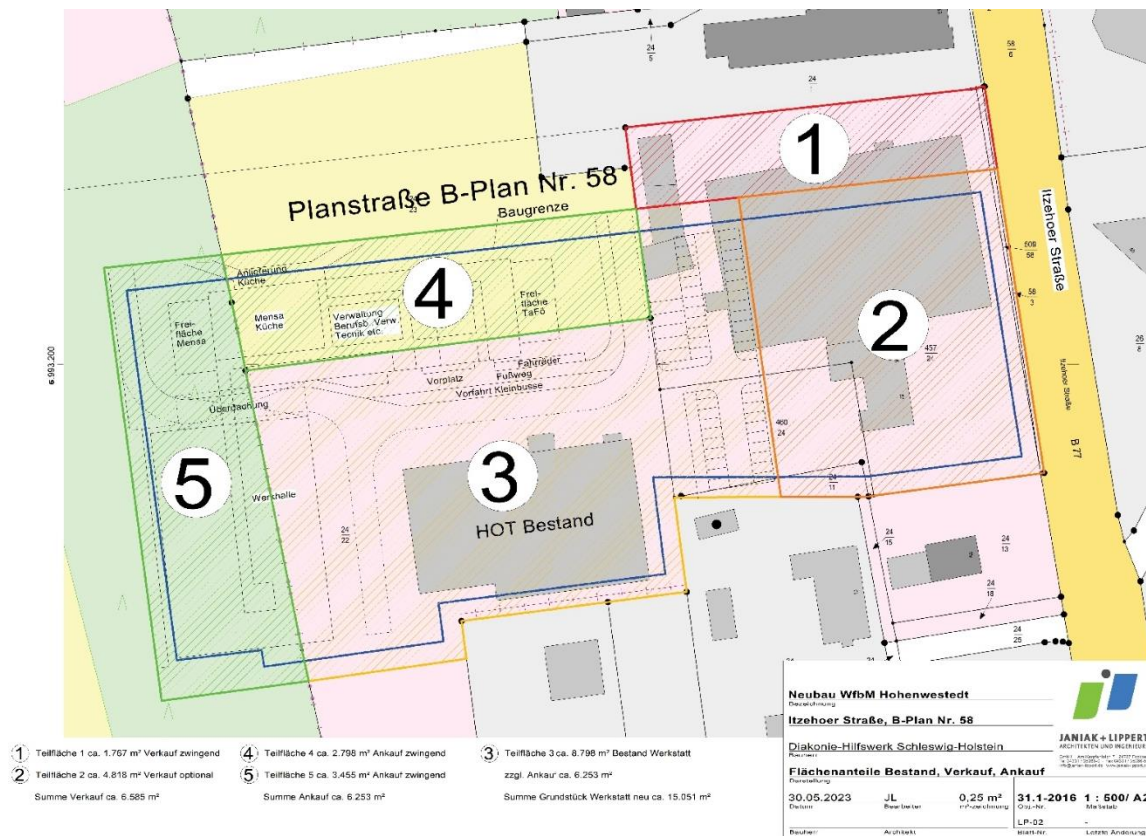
Lageplan Diakonie Hilfswerk (Architekten und Ingenieure Janiak + Lippert)
